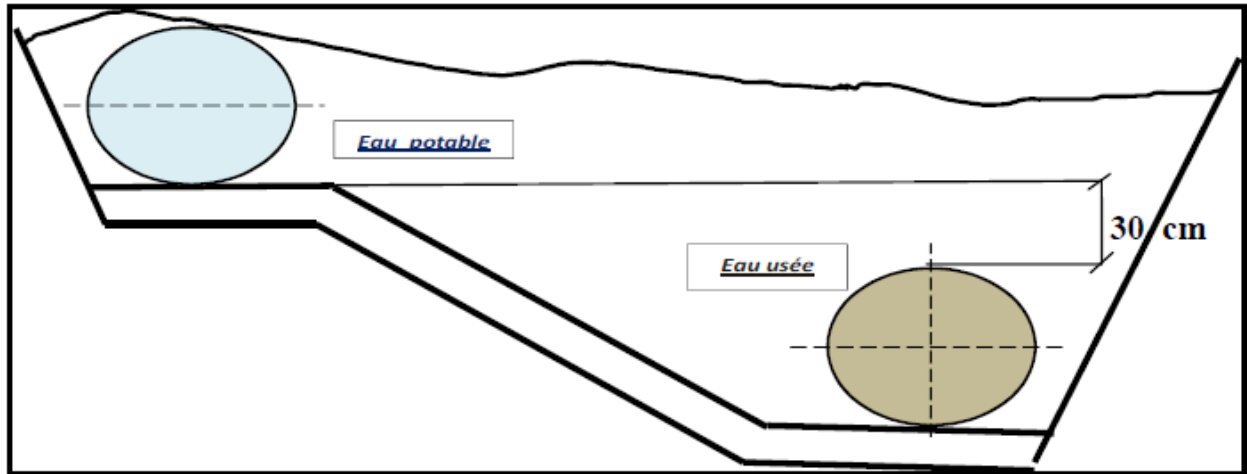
Pose à proximité d'une conduite d'assainissement.
